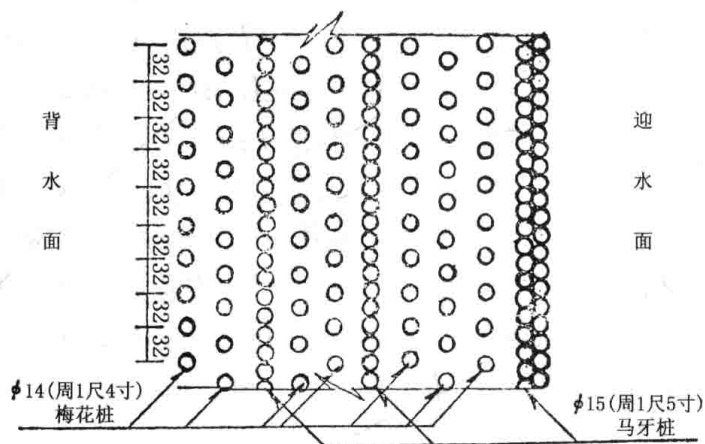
清代鱼鳞石塘基桩平面布置图
